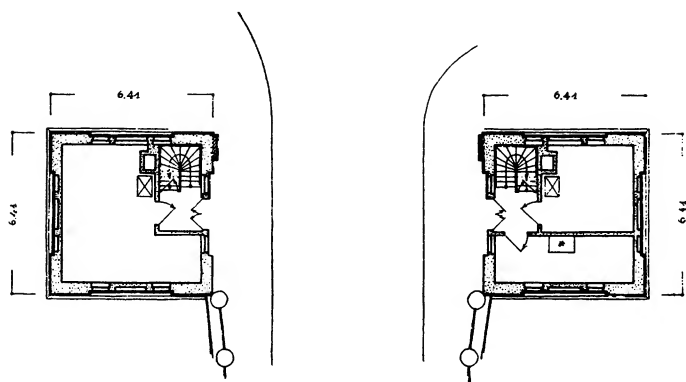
Grundrisse der Muldbrückenhäuser (Maßstab 1:300)
